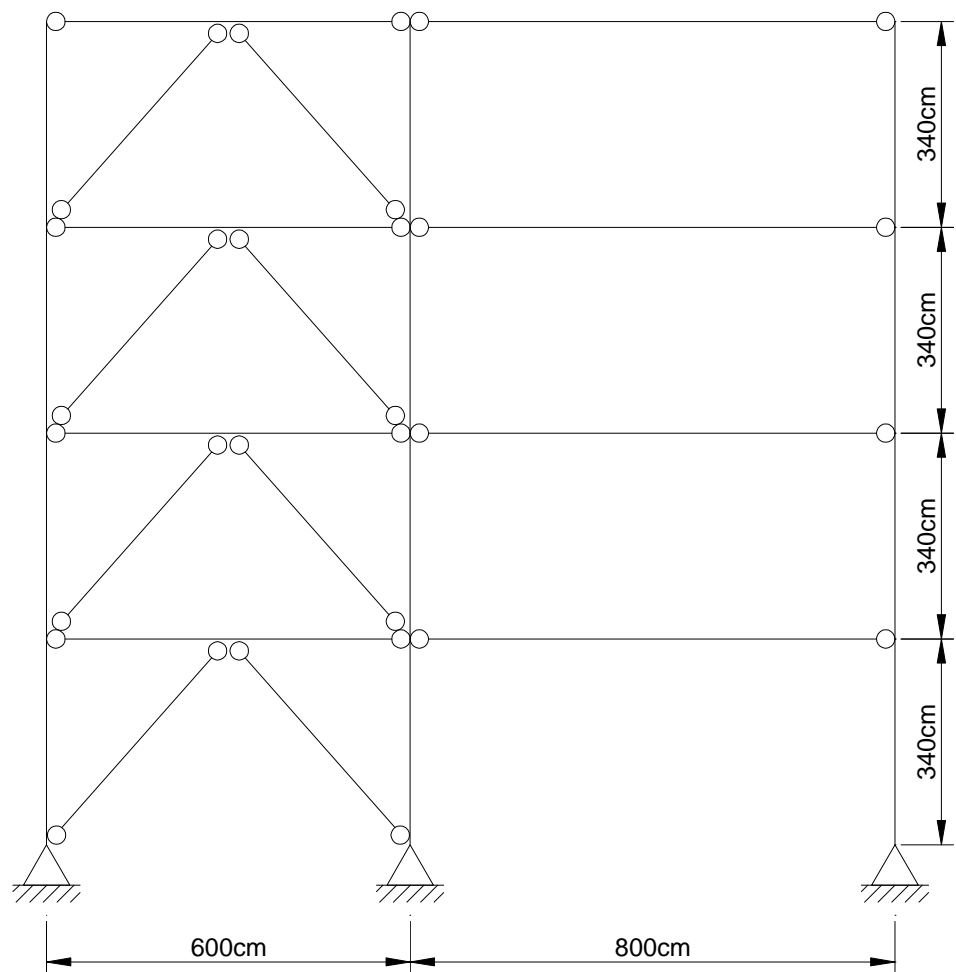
Tipologia utilizada no pórtico plano contraventado com barras de aço do caso A2.
